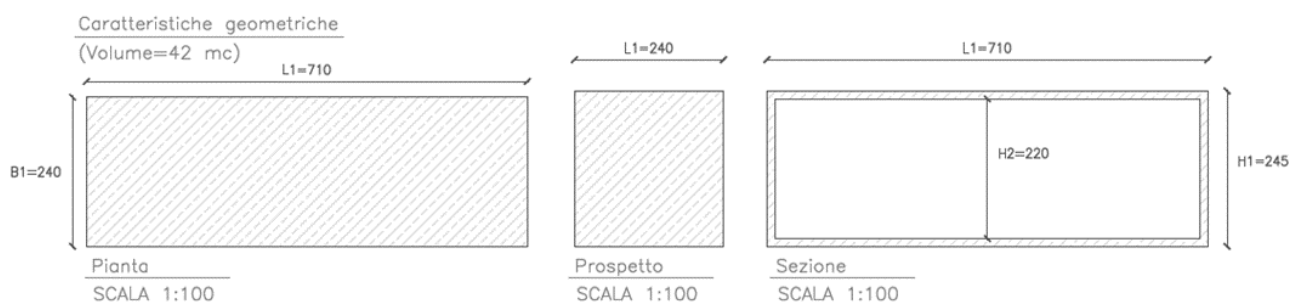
Pianta e prospetti box deposito schiumogeni in progetto
